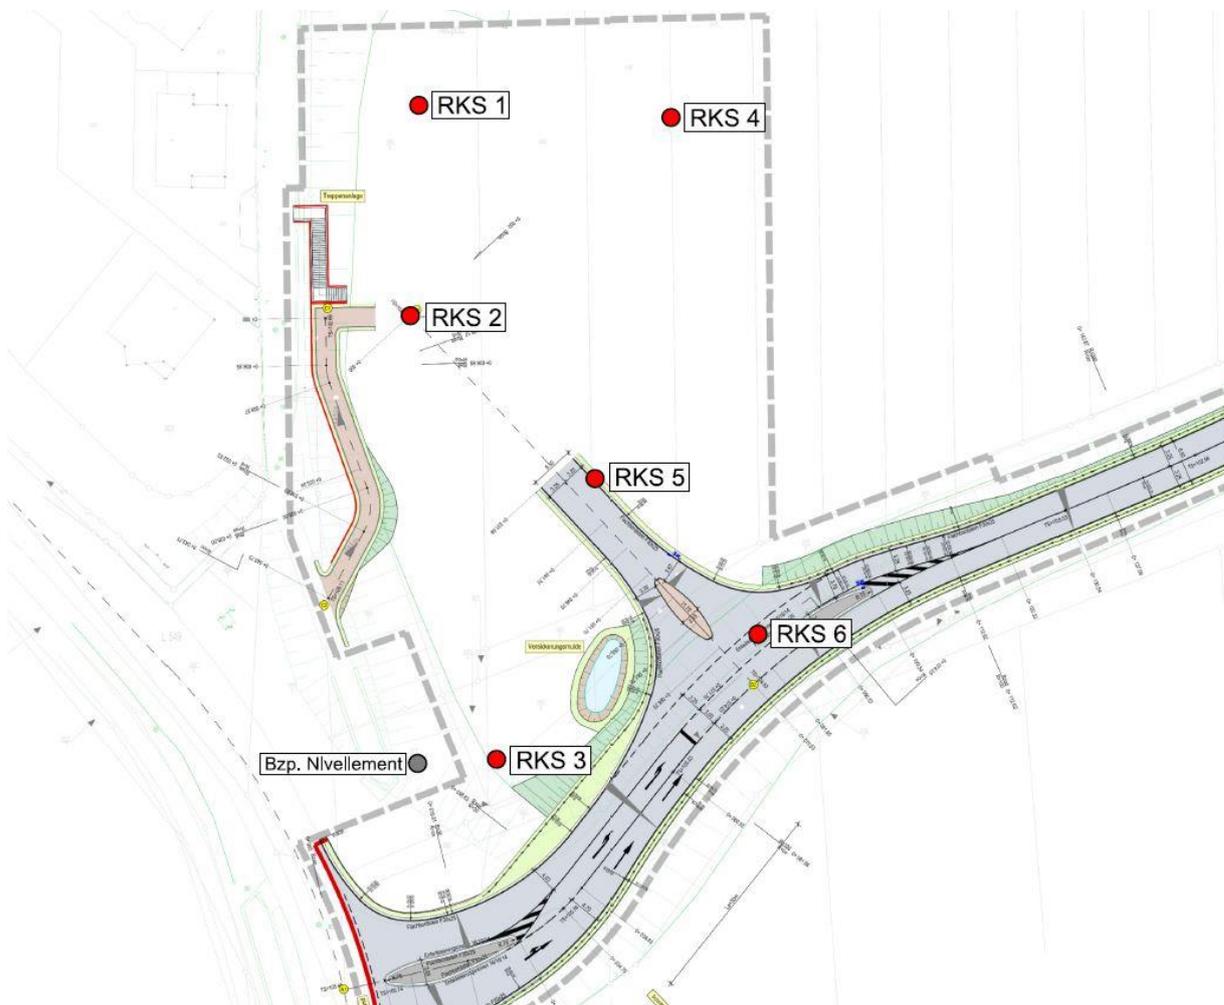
Lageplan der geotechnischen Aufschlusspunkte
